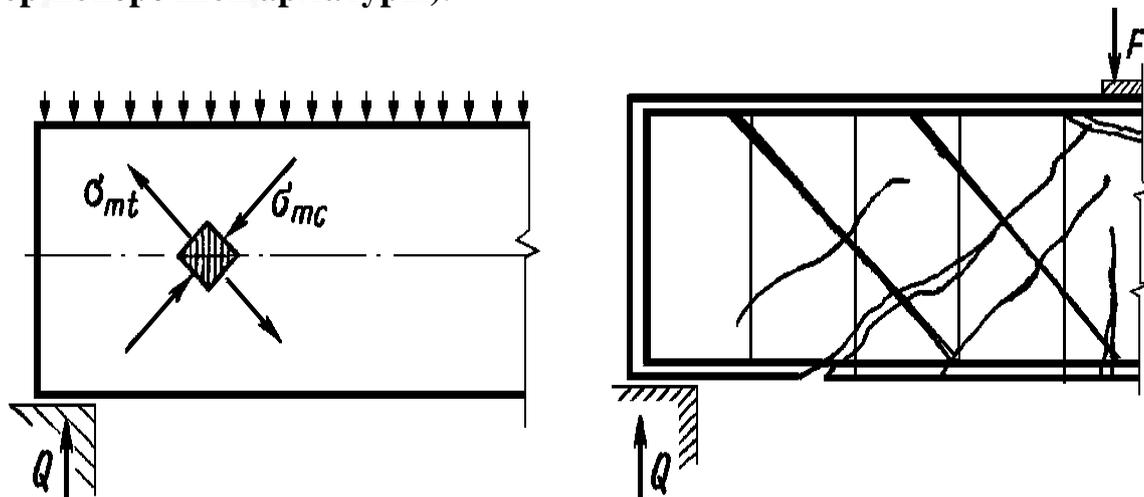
Главные напряжения в бетоне у опоры балки и разрушение изгибаемого элемента по наклонному сечению
